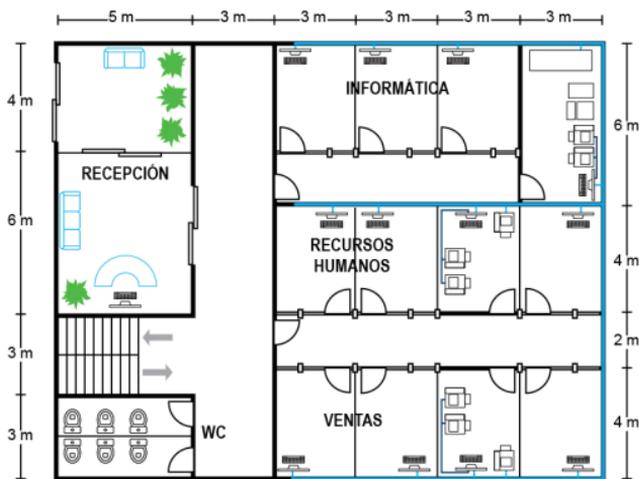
Ejemplo de planificación de cableado estructurado.
